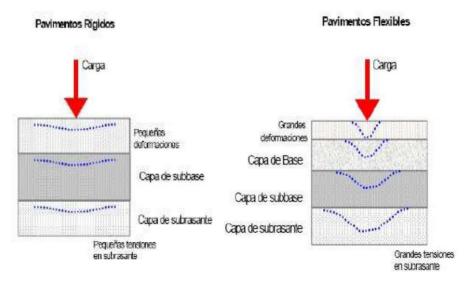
Diferencias de la estructura de un pavimento rígido y un pavimento flexible
